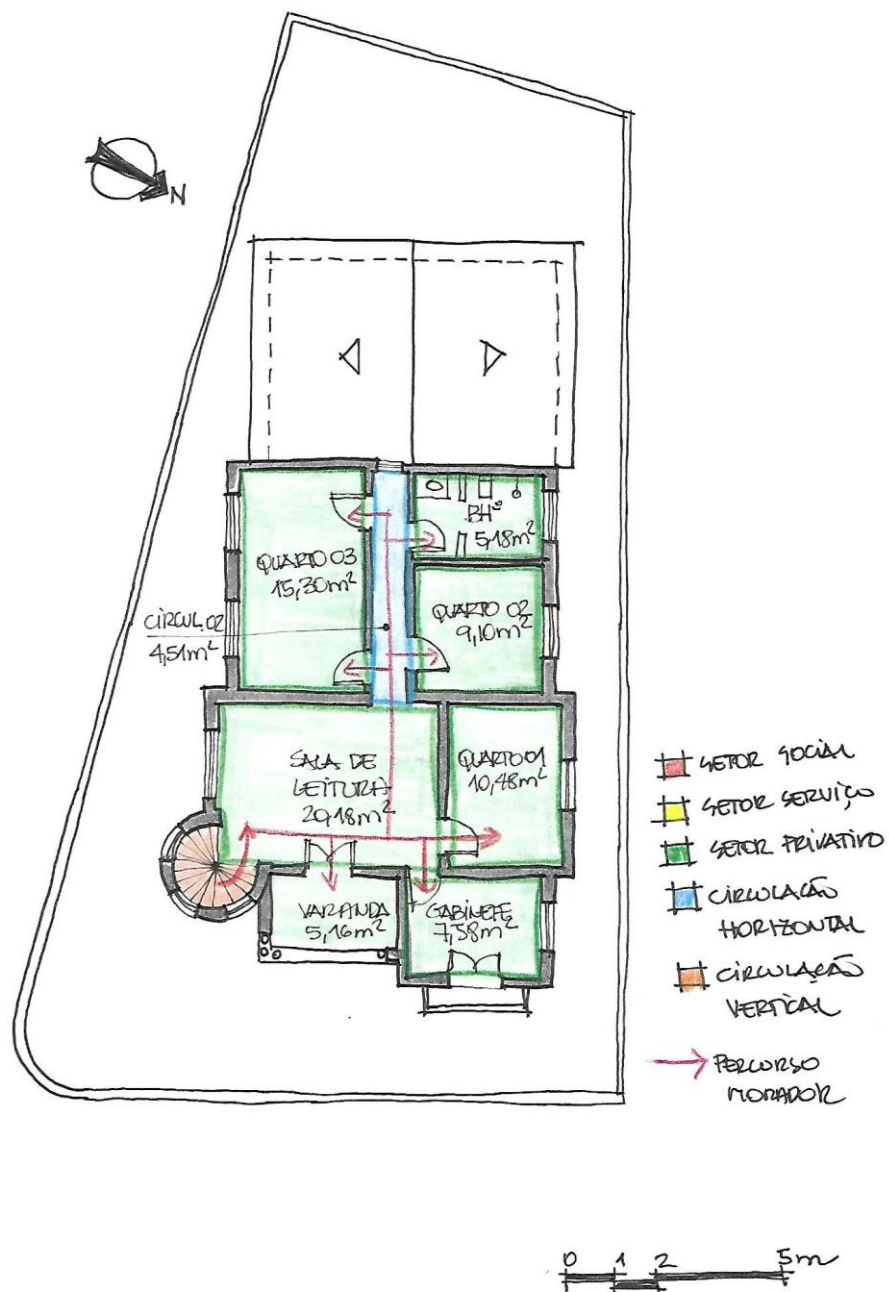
Planta do pavimento superior da Residência Nº 220. Fonte: autora, 2018.
